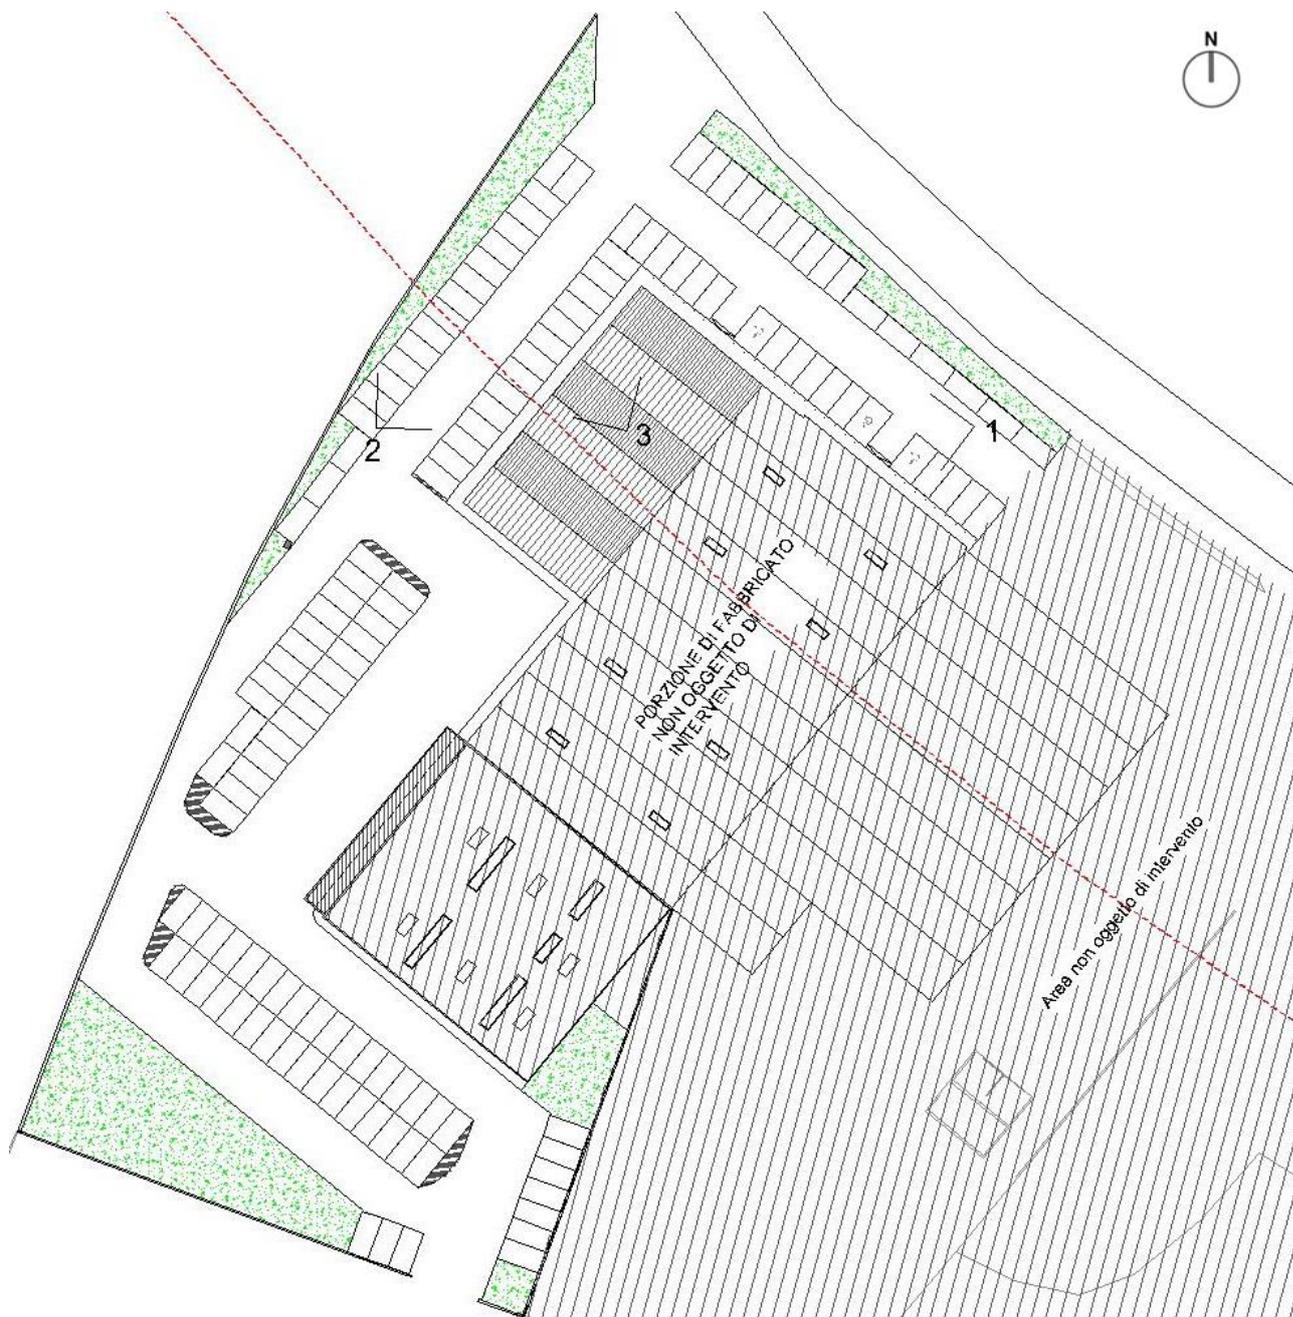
planimetria con indicazione dei coni di ripresa fotografica foto ante lavori SCIA presentata il 04.05.2017
